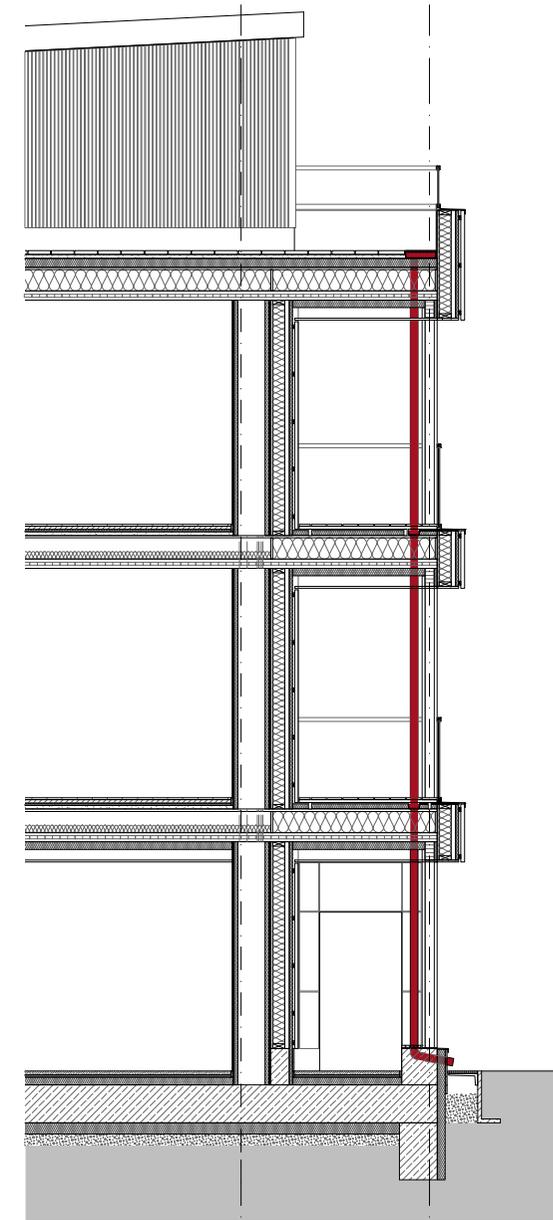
Fassadenschnitt Entwässerung M 1:100
